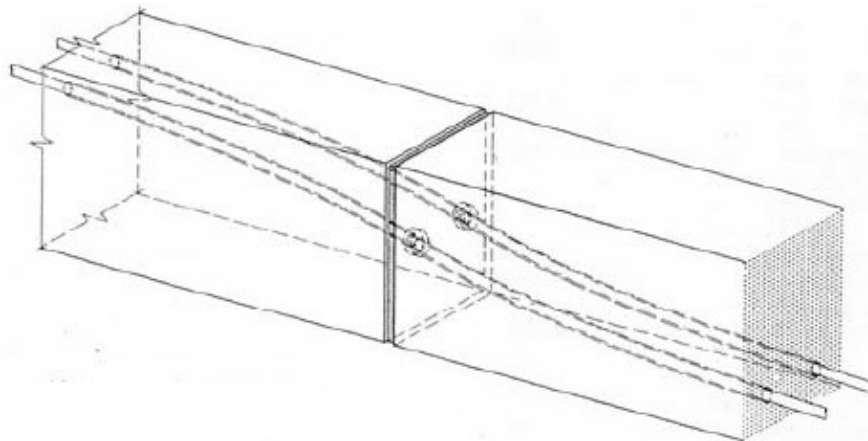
Ligação viga – viga com ligação por pré-esforço (STUPRÉ, 1981).
